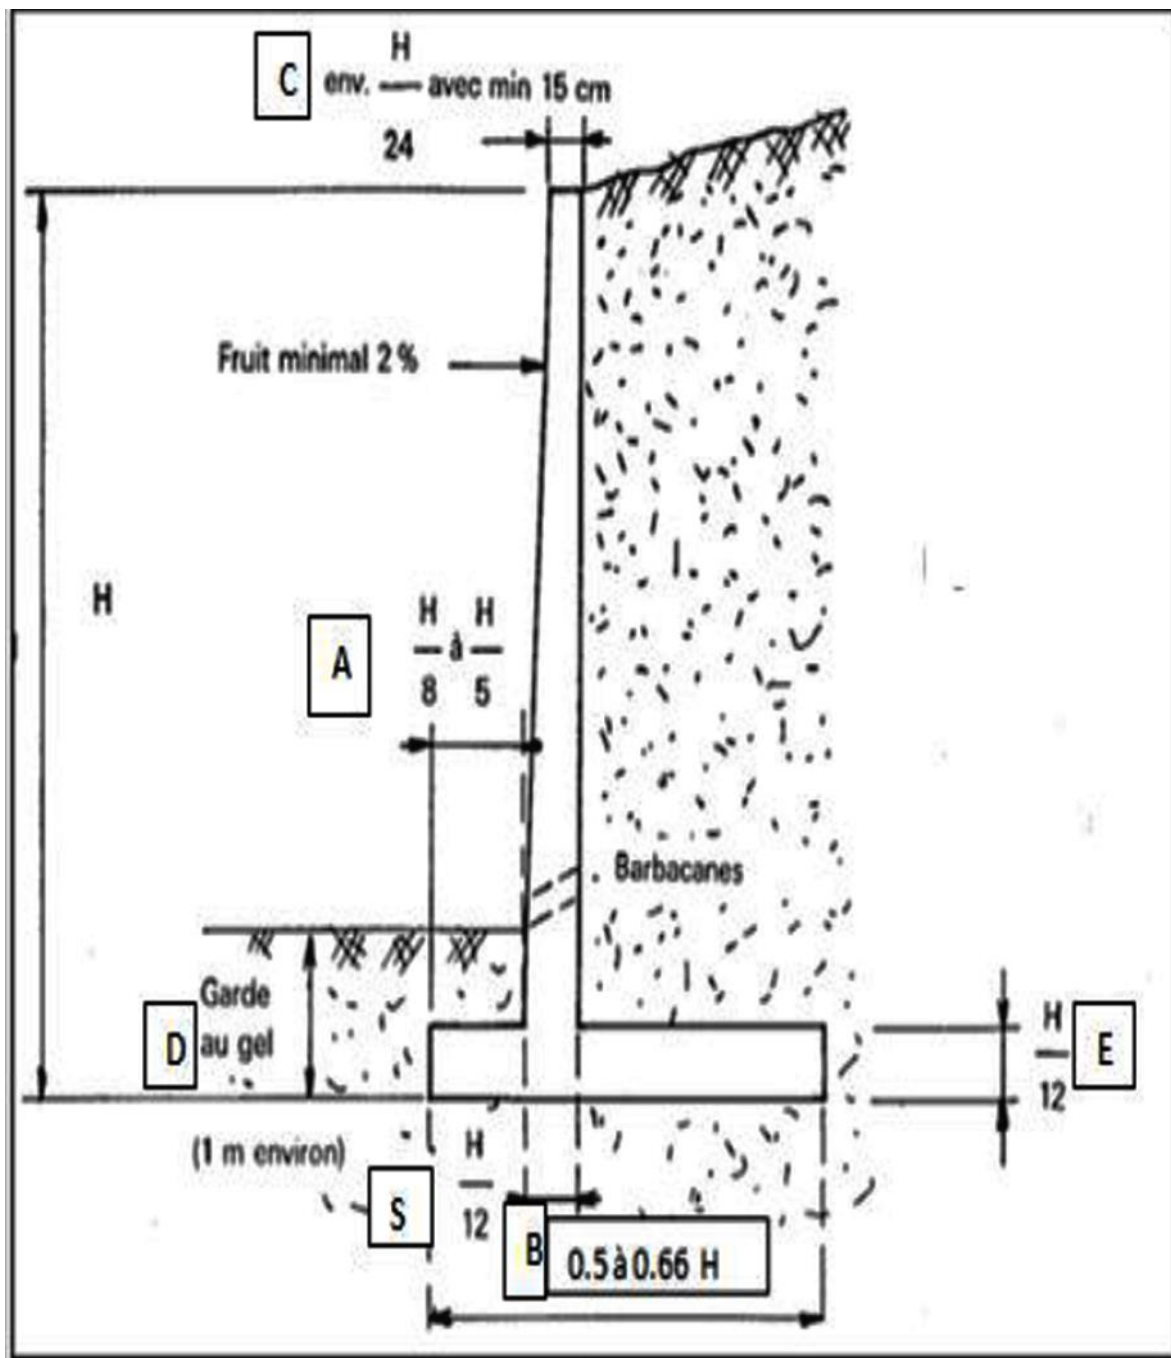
pré-dimensionnement d'un mur de soutènement
